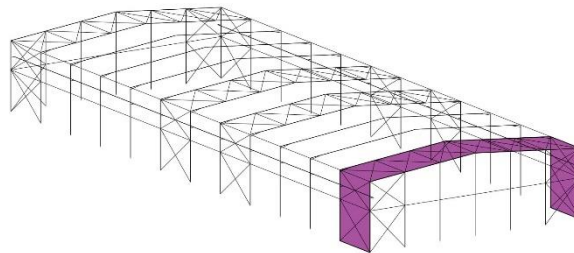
Sistema contraviento. Fuente: Elaboración propia
